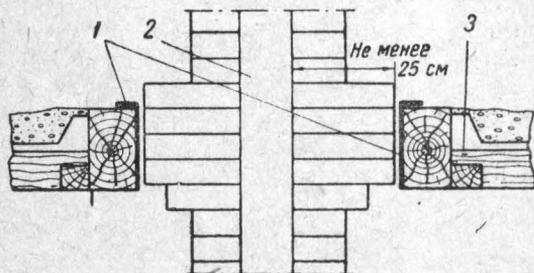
Устройство горизонтальной разделки в перекрытии:
